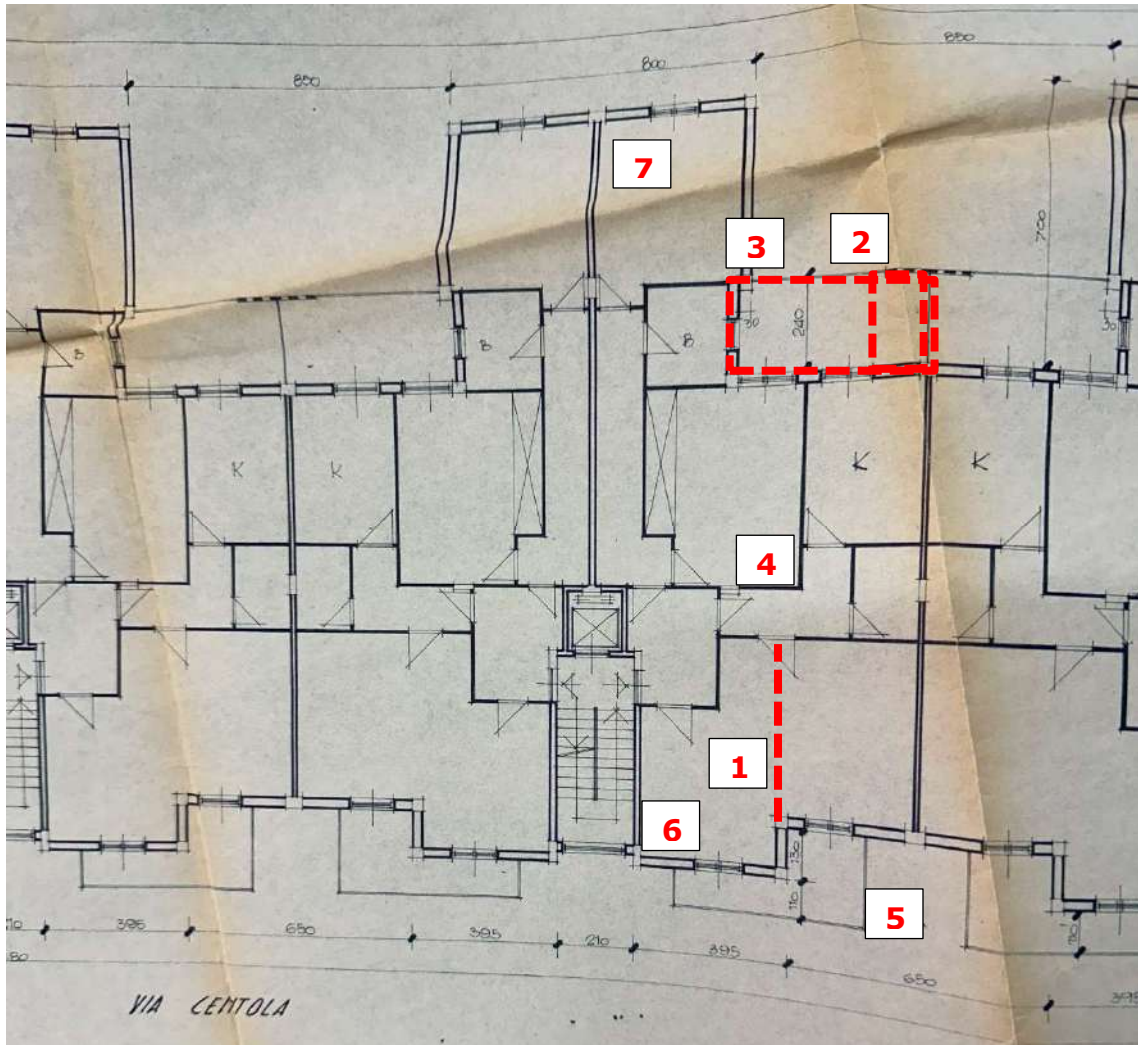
Stralcio di planimetria approvata dal Comune di Bitonto con Licenza Edilizia n. 82/1972.
